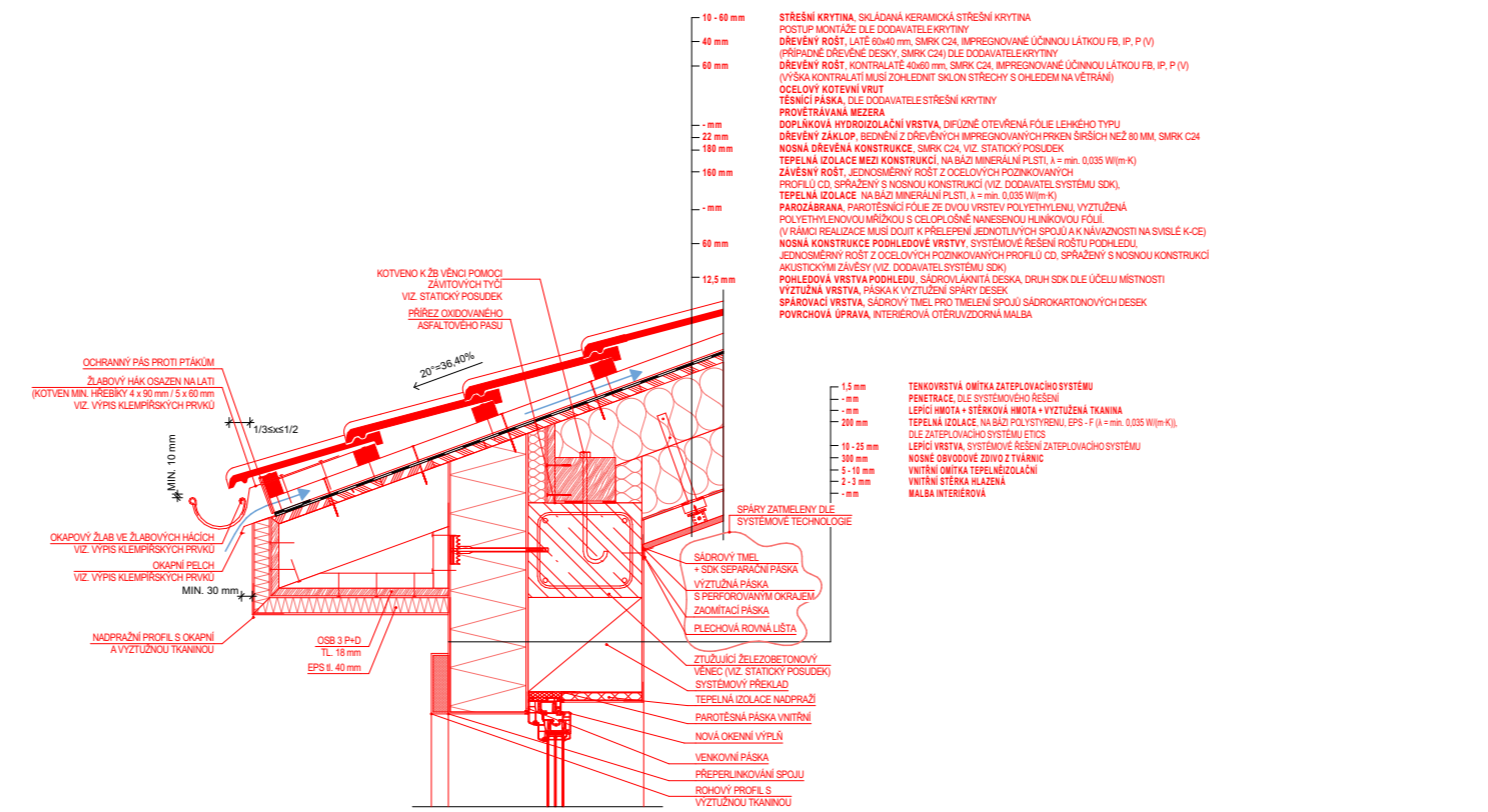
DETAIL STŘEŠNÍ KONSTRUKCE - HLAVNÍ ŘÍMSA A OKAPOVÁ ČÁST - D.5
